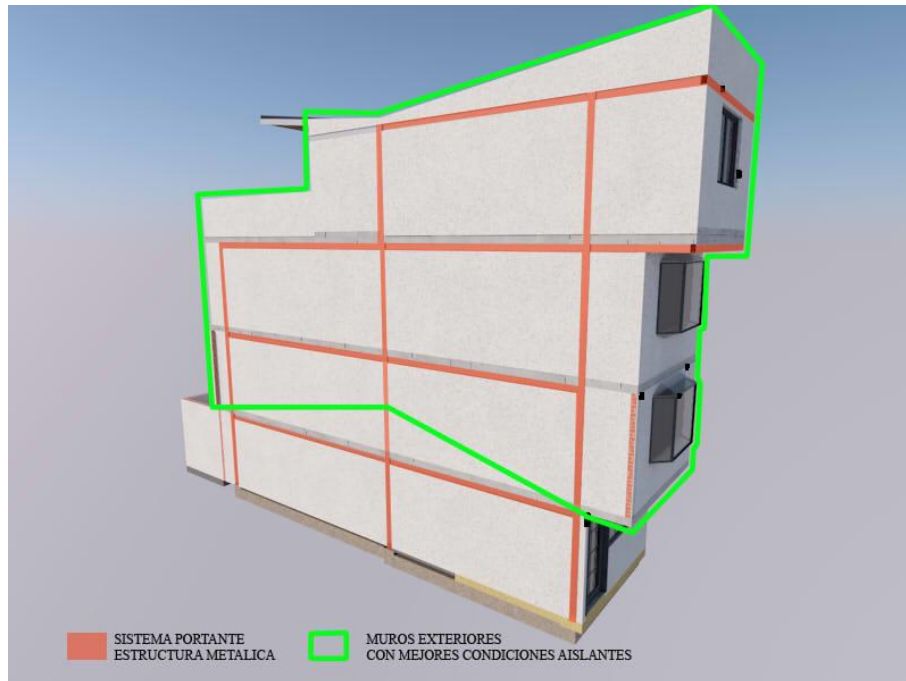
Imagen en corte indicando sistema estructural portante y zona de muro exterior a cubrir para evitar filtraciones por humedad. Elaboración propia 2017.
